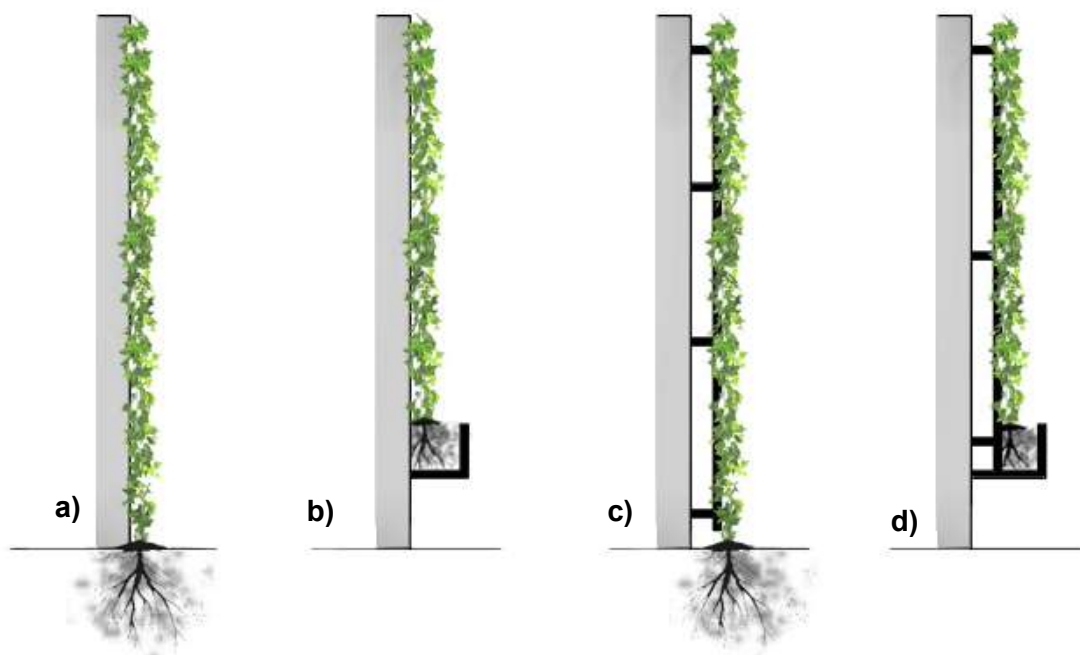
Tipologias de Fachada verde e forma de plantação: a) Fachada verde direta com plantação no solo; b) Fachada verde direta sem plantação no solo; c) Fachada verde indireta com plantação no solo; d) Fachada verde indireta sem plantação no solo (Fonte: Autor adaptado de (Ottelé, 2011))
